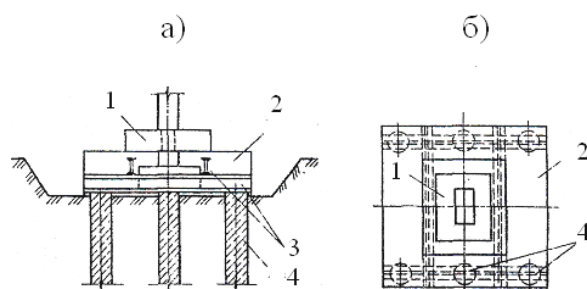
Усиление столбчатого фундамента выносными сваями с устройством ростверка, армированного металлическими балками: а)- разрез; б)- план:
